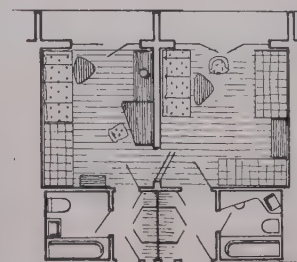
Einbett- und Zweibett-Zimmer als Appartement gruppiert 1 : 200
